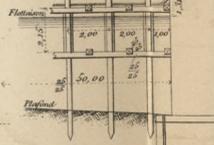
Coupe en travers de l'Estacade (Dinant).
